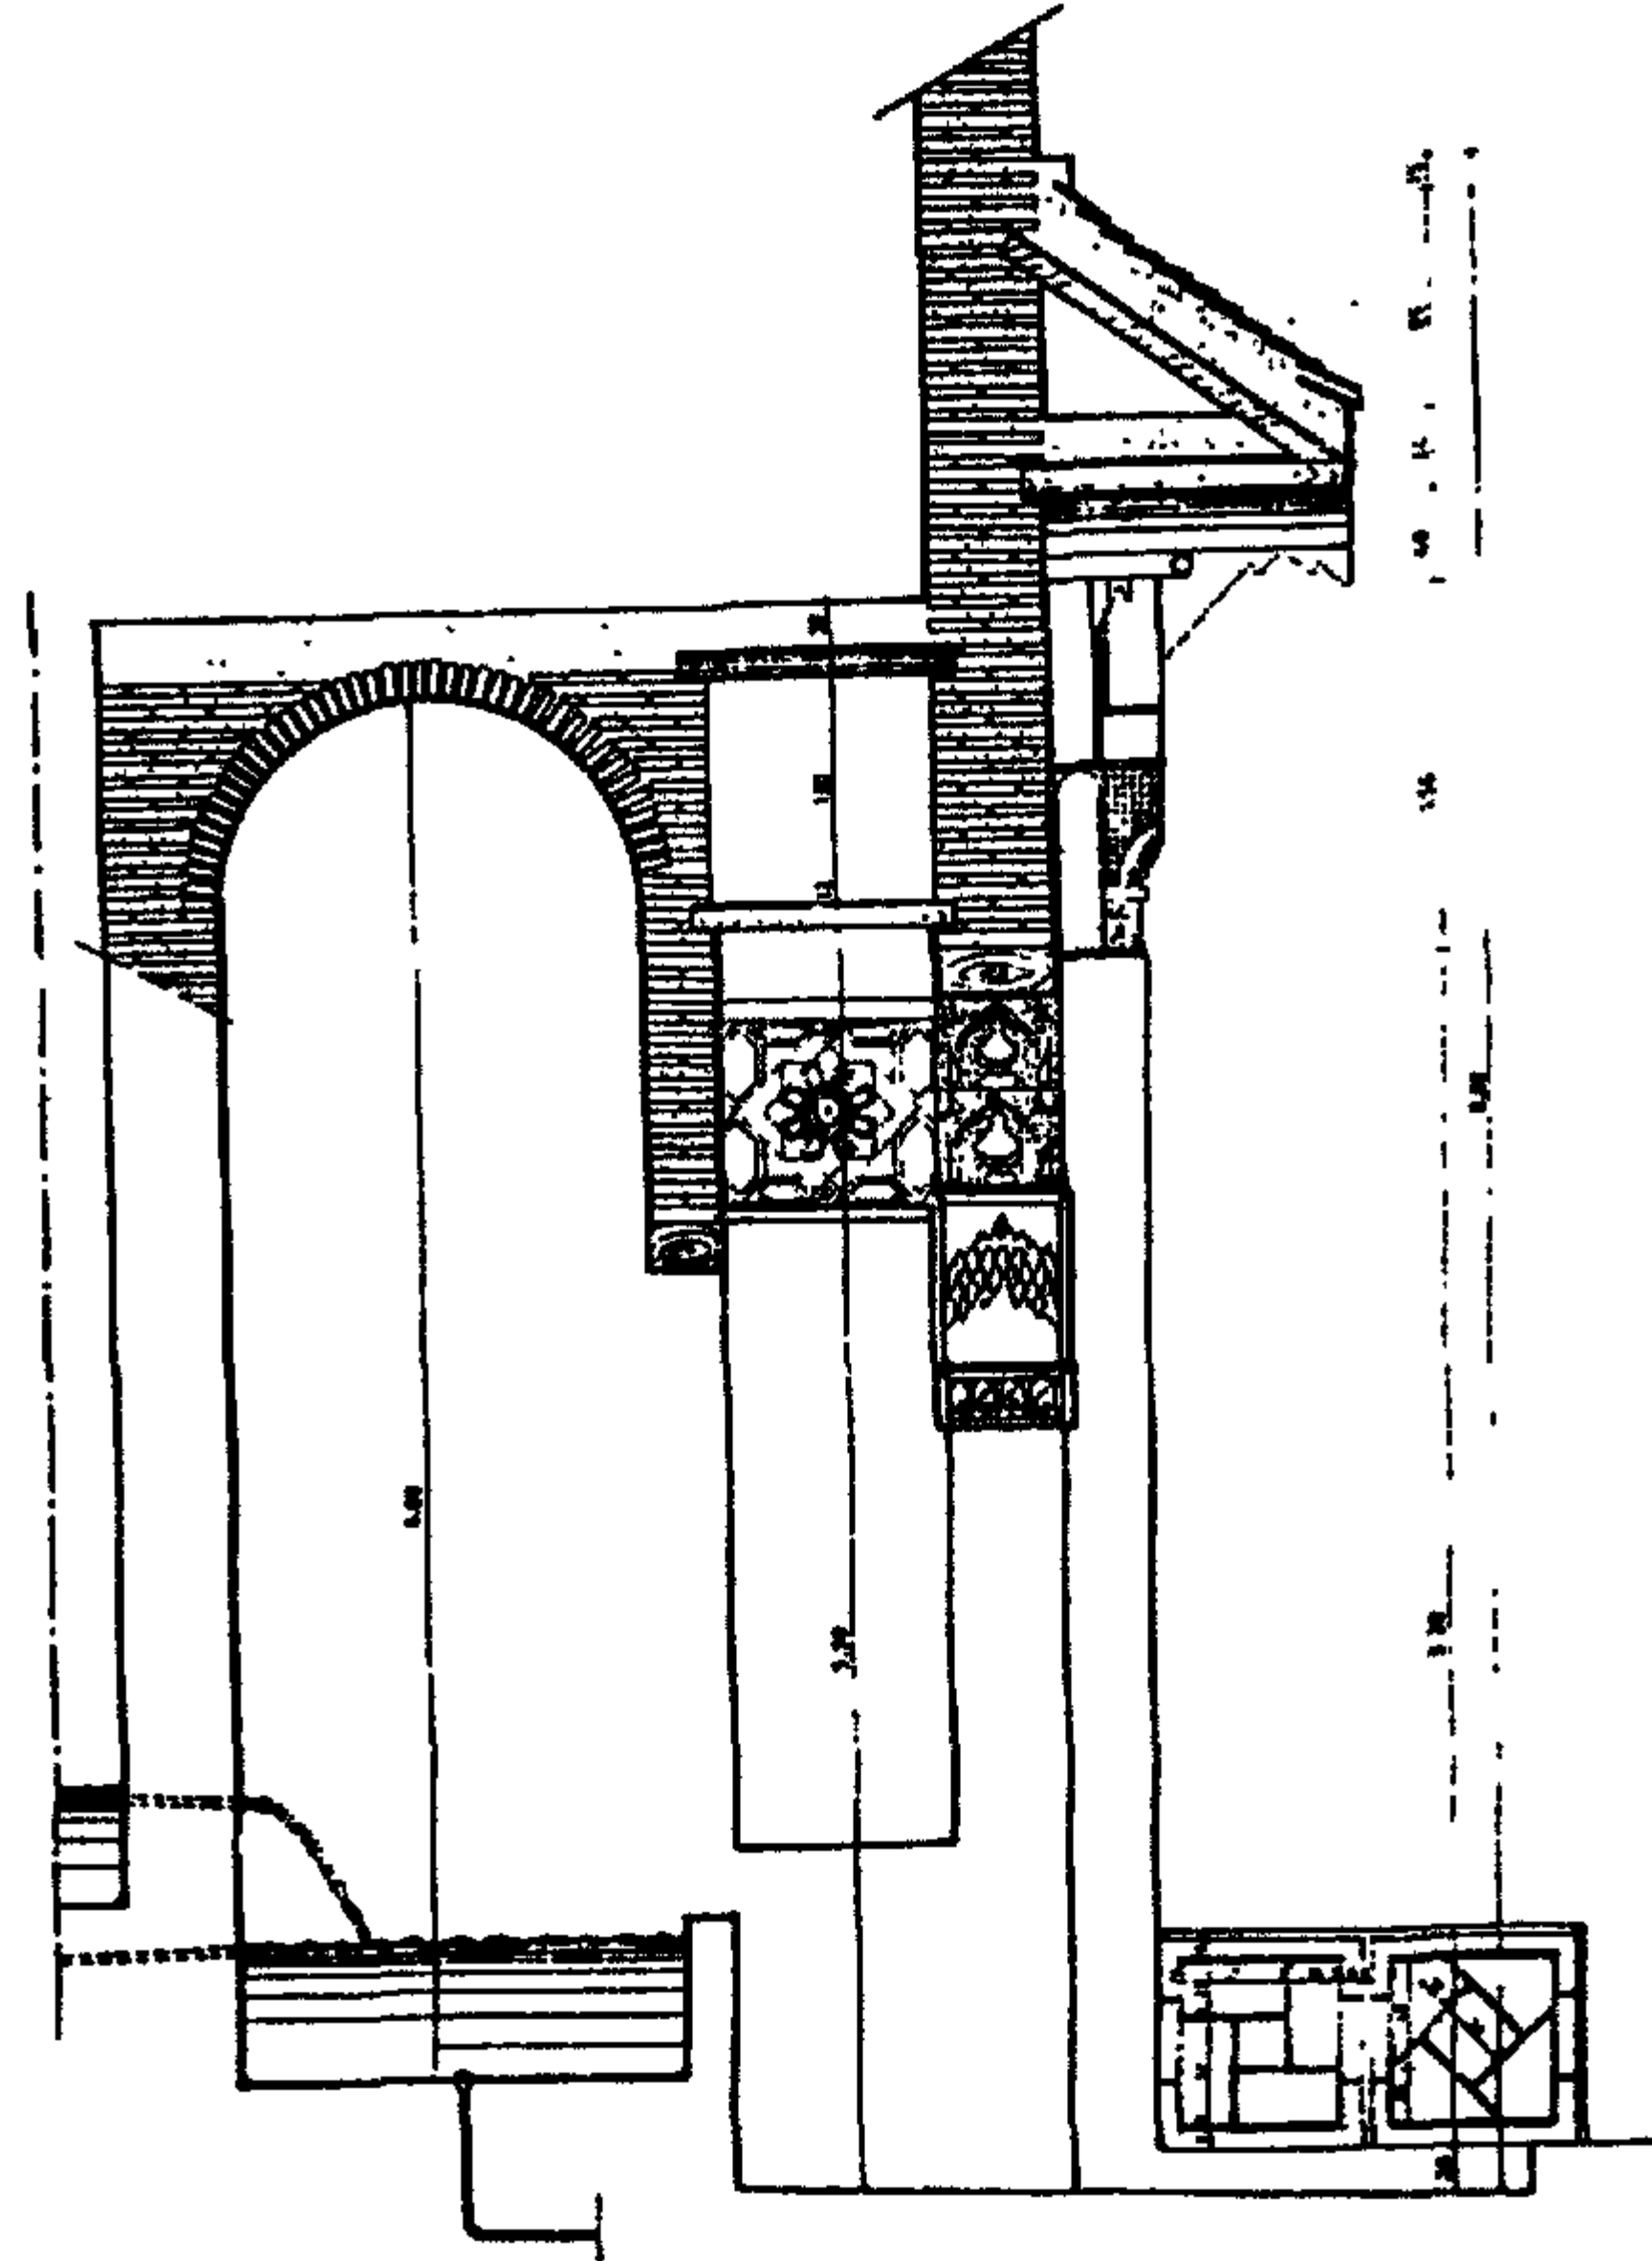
مسقط أفقي للسقاية التابعة لجامع المآسين بمراكش.
